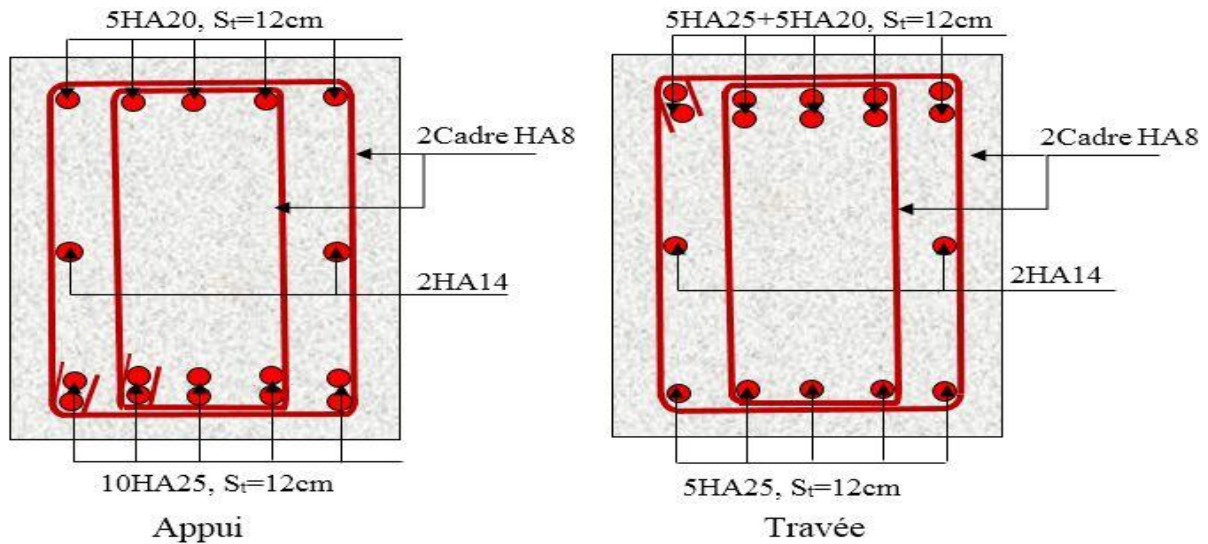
Schémas de ferrailage des nervures sens y-y
